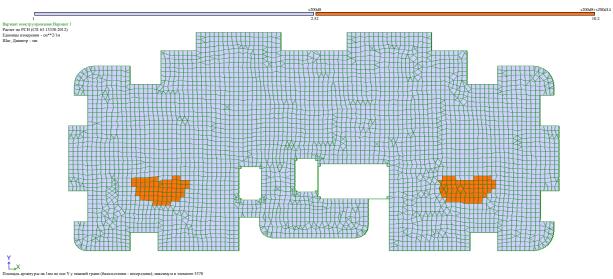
Площадь арматуры на 1пм по Y у нижней грани
